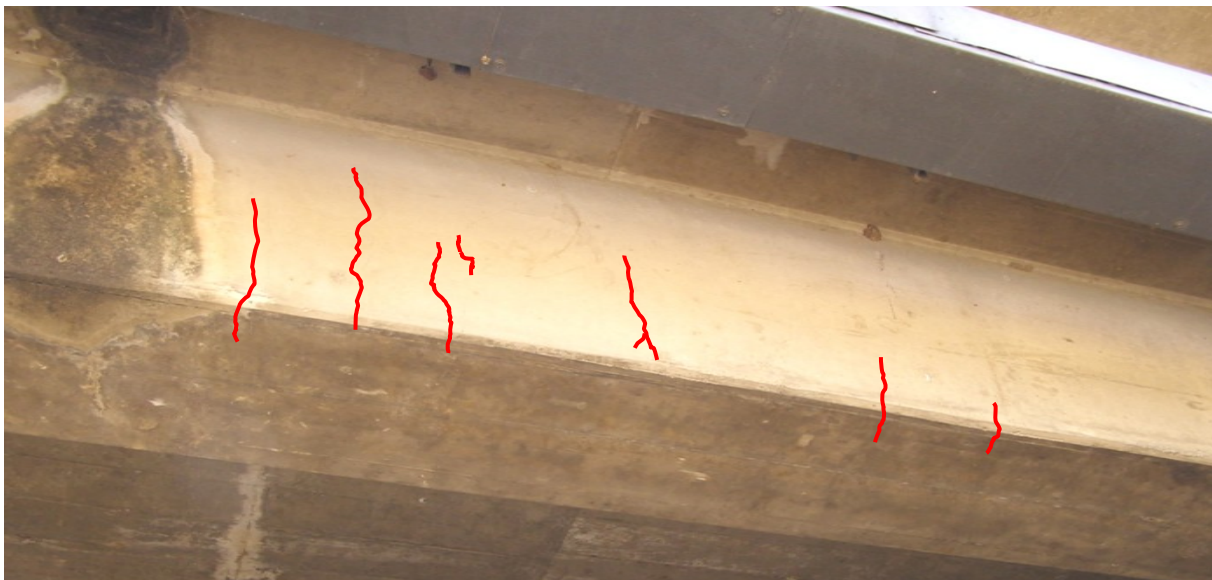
Detalle típico de grietas por flexión en las vigas principales al centro del claro entre la pila 2 y el bastión 2 (detalle típico).
